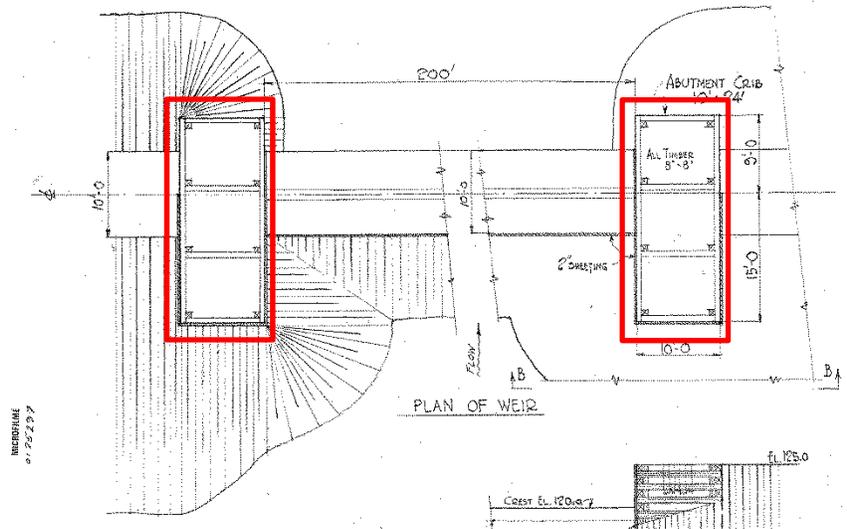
STRCT1 – Vue en plan du seuil en béton 1941 (±PM 200 à 270)
